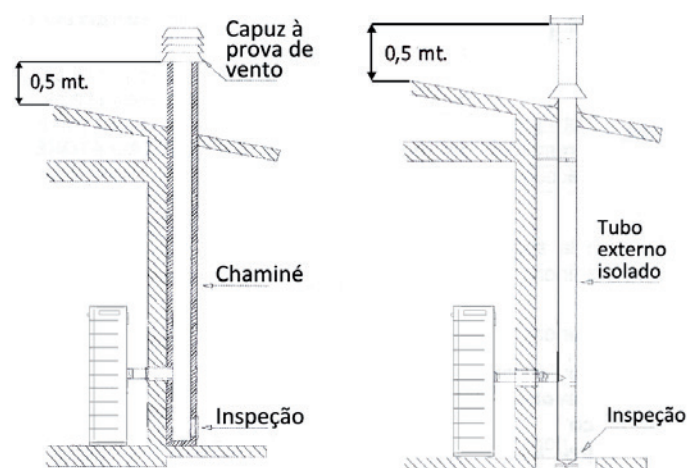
ligação à chaminé Fig. 3: ligação a um tubo externo com tubo isolado ou parede dupla
